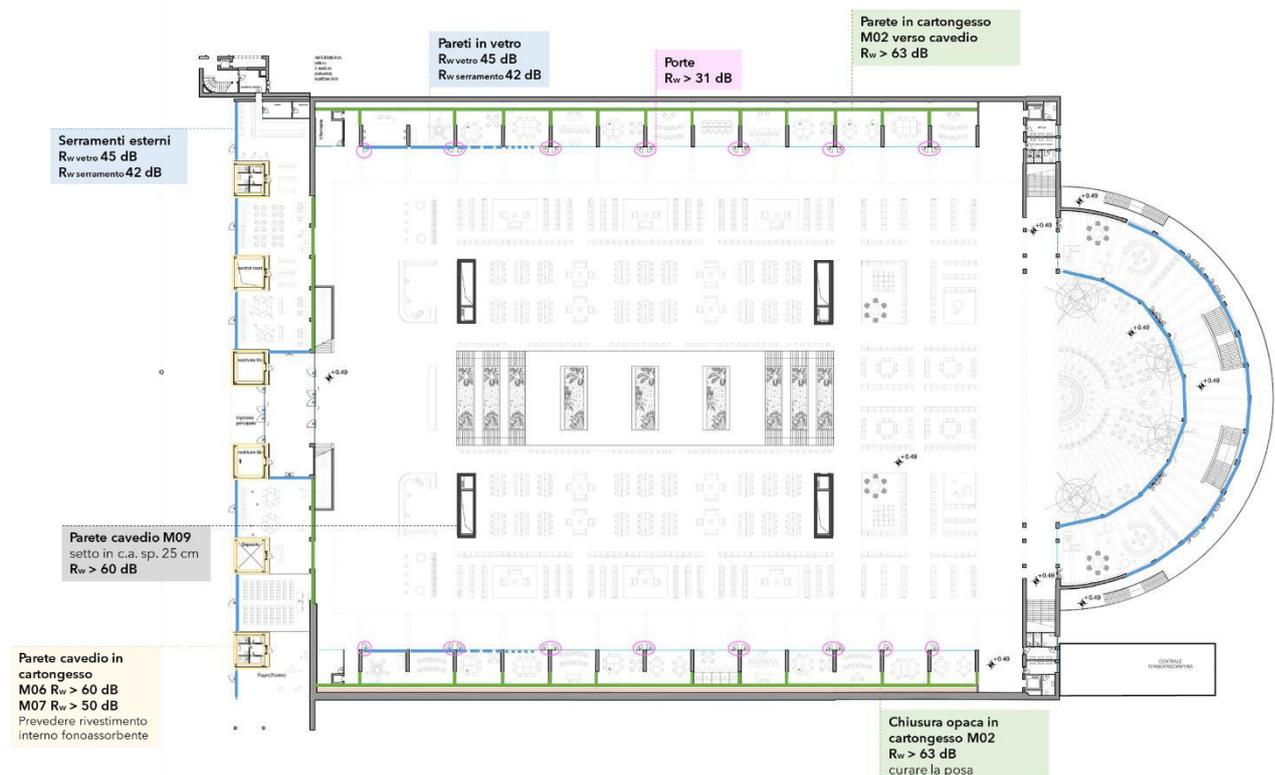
Stato di progetto. Definizione delle prestazioni dei componenti edilizi. Piano terra.
